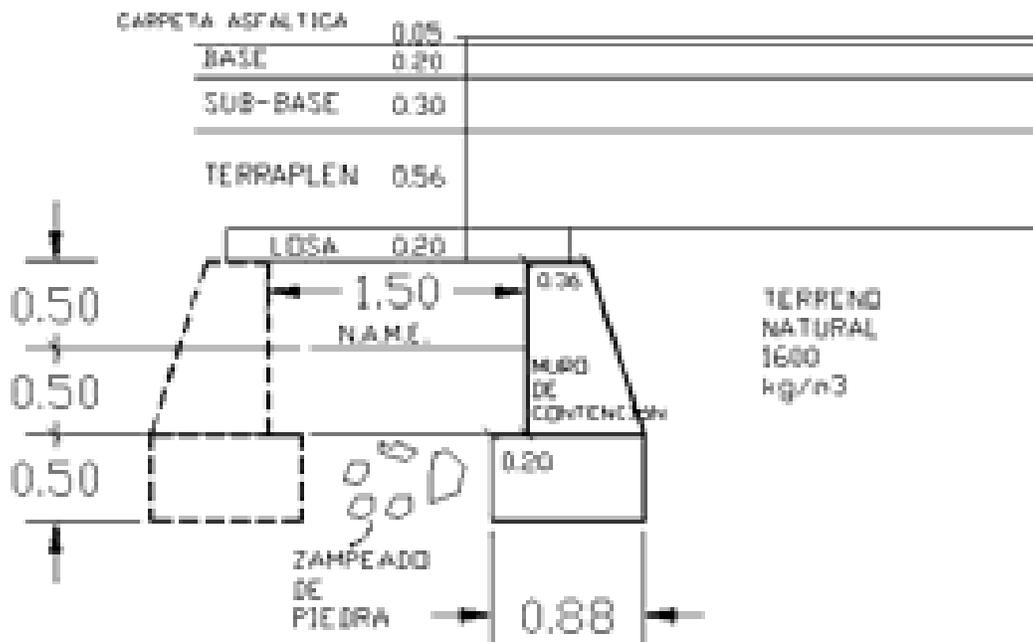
Partes que forman la alcantarilla del kilometro 11+302.
